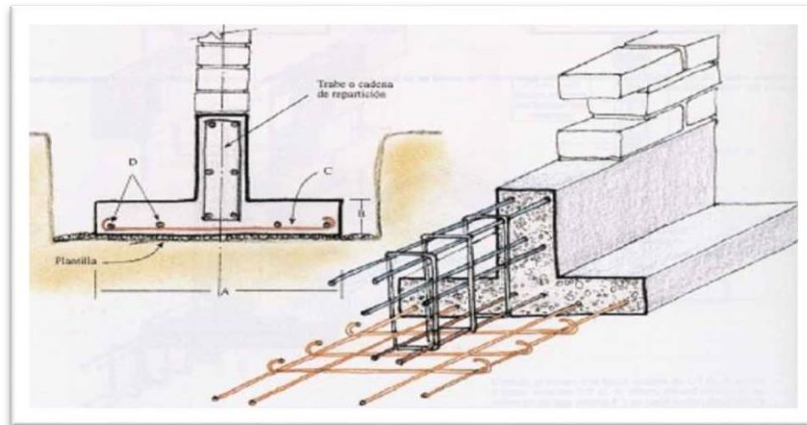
Blog Constructor civil. (28 de mayo de 2012). Zapatas corridas de concreto armado - Detalles constructivos. Septiembre 2020, de Blog Constructor civil Sitio web: <https://www.elconstructorcivil.com/2012/05/zapatas-corridas-de-concreto-armado.html>
